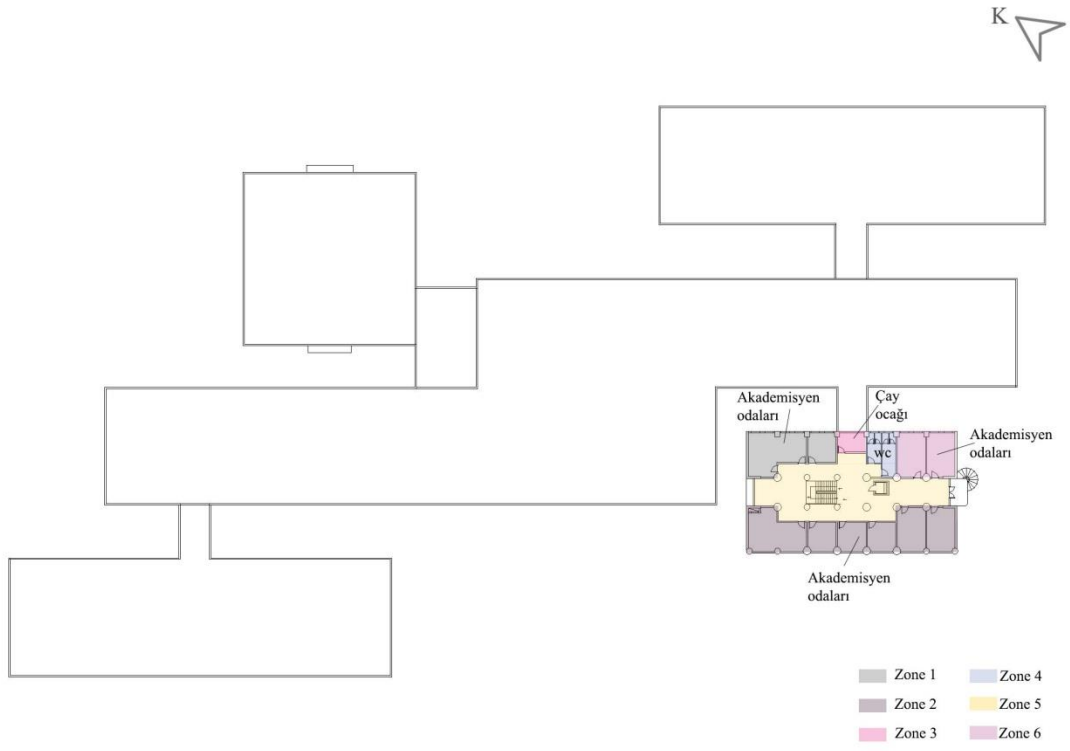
M.M.F binası 4.,5.,6. ve 7. katlar planı ve ısı bölgeleme.
